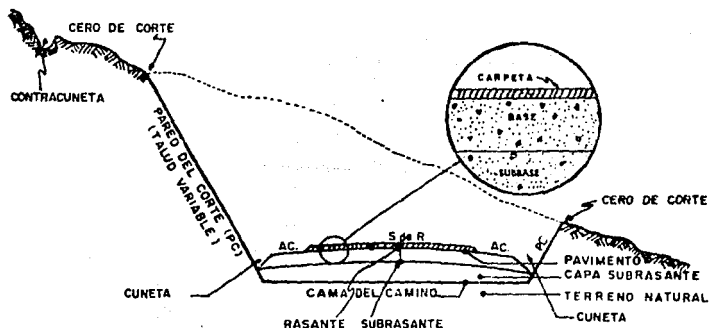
Sección transversal típica en corte, para carreteras de dos carriles; se muestra un detalle de pavimento flexible.
